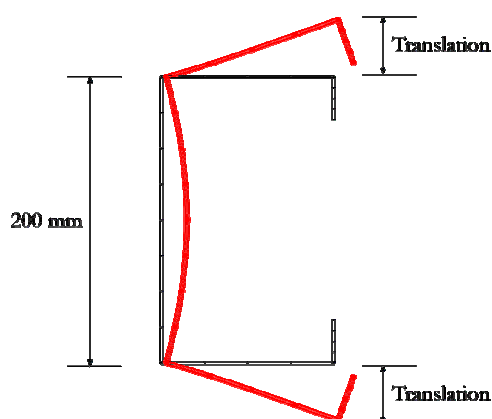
Instabilité distorsionnelle d'une section en C uniformément comprimée
